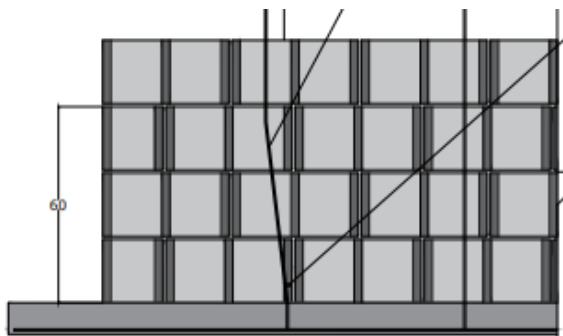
Acero vertical con bayoneteo gradual. Fuente del autor
